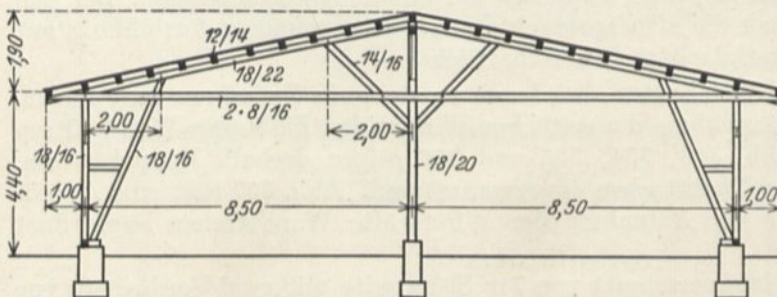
Zweischiffige Halle mit Pfettendach und kleinen Auskragungen.
